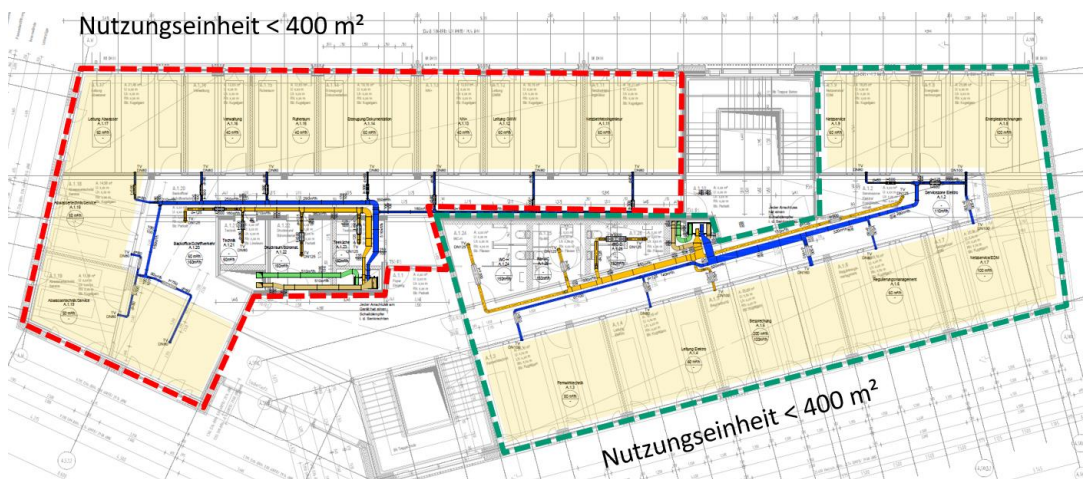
Lüftungsinstallationen – exemplarisch für das Erdgeschoss
